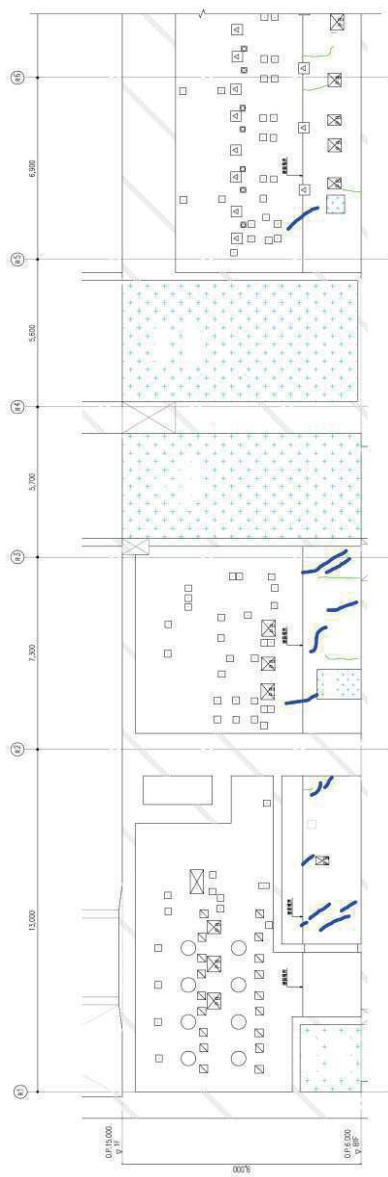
原子炉建屋のひび割れ分布 耐震壁 (23) 地下1階 R11 通り
